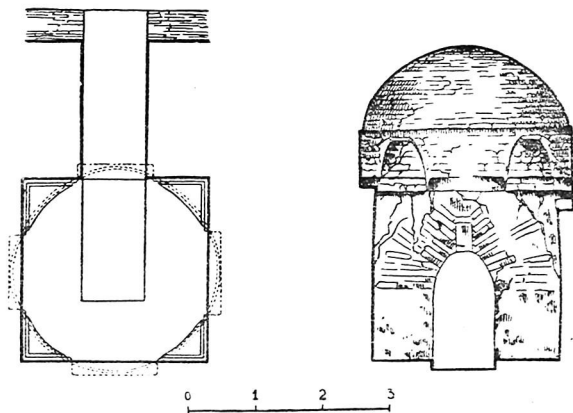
Купольная комната кешка второго этажа, план в разрезе (реконструкция).
